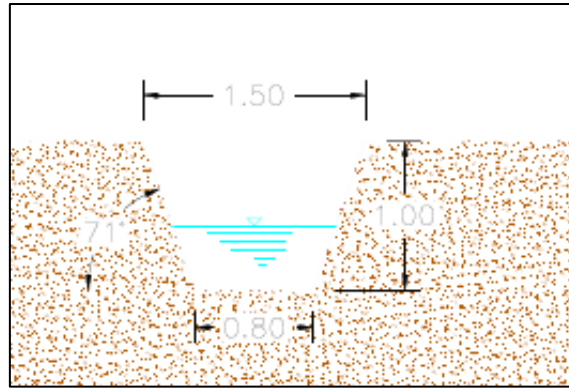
Sezione canali di drenaggio interni – Area Nord, Ovest e Sud – Stralcio tavola progettuale
